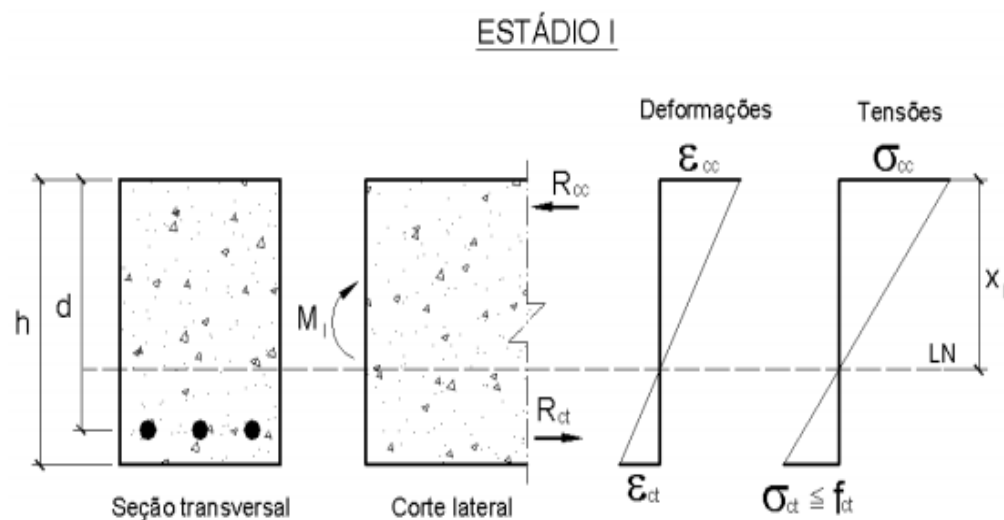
ESTÁDIO I DE FISSURAÇÃO
